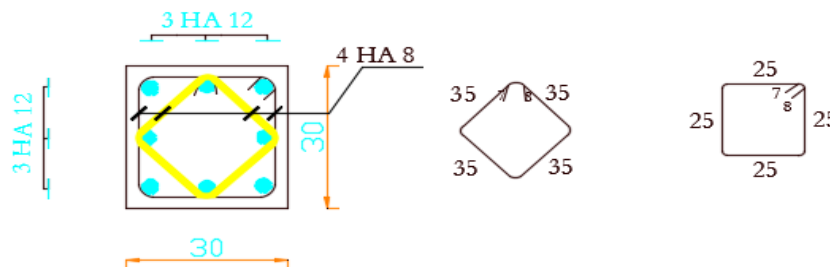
coupe transversale de ferrailage poteaux 30 x 30 cm²
